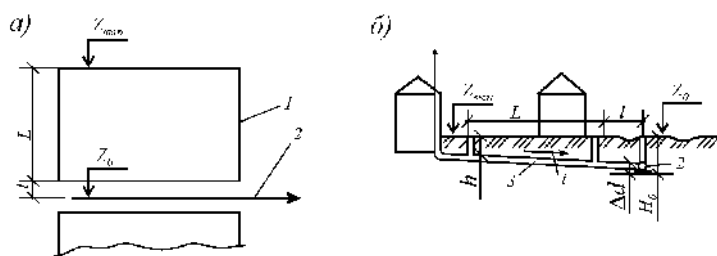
Расчетные схемы к определению начальной минимальной глубины заложения уличного трубопровода:
